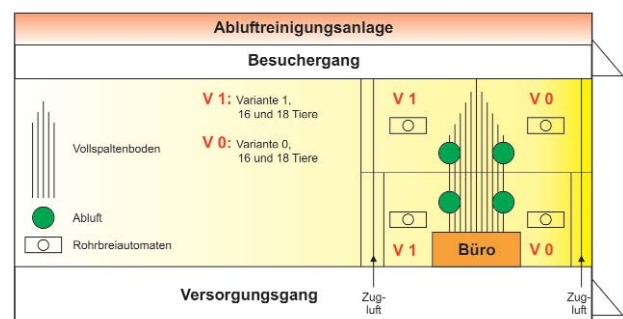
Grundriss des Versuchsstalles des Institutes für Betriebstechnik und Bauforschung der FAL in Braunschweig
